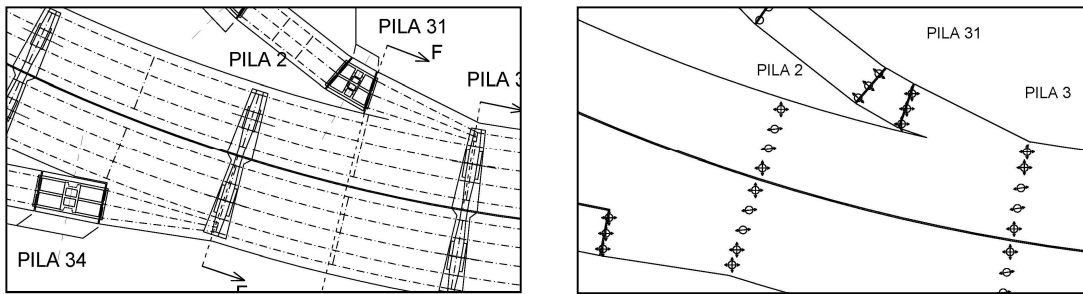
Tracciato travi tratto finale rampe e disposizione ddv
